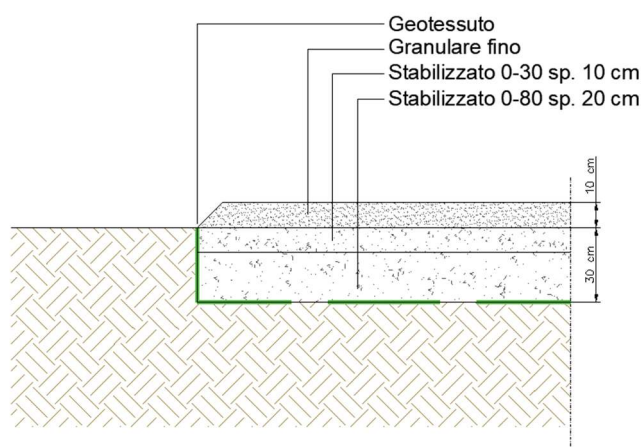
Sezione tipo viabilità interna all'impianto e piazzali
